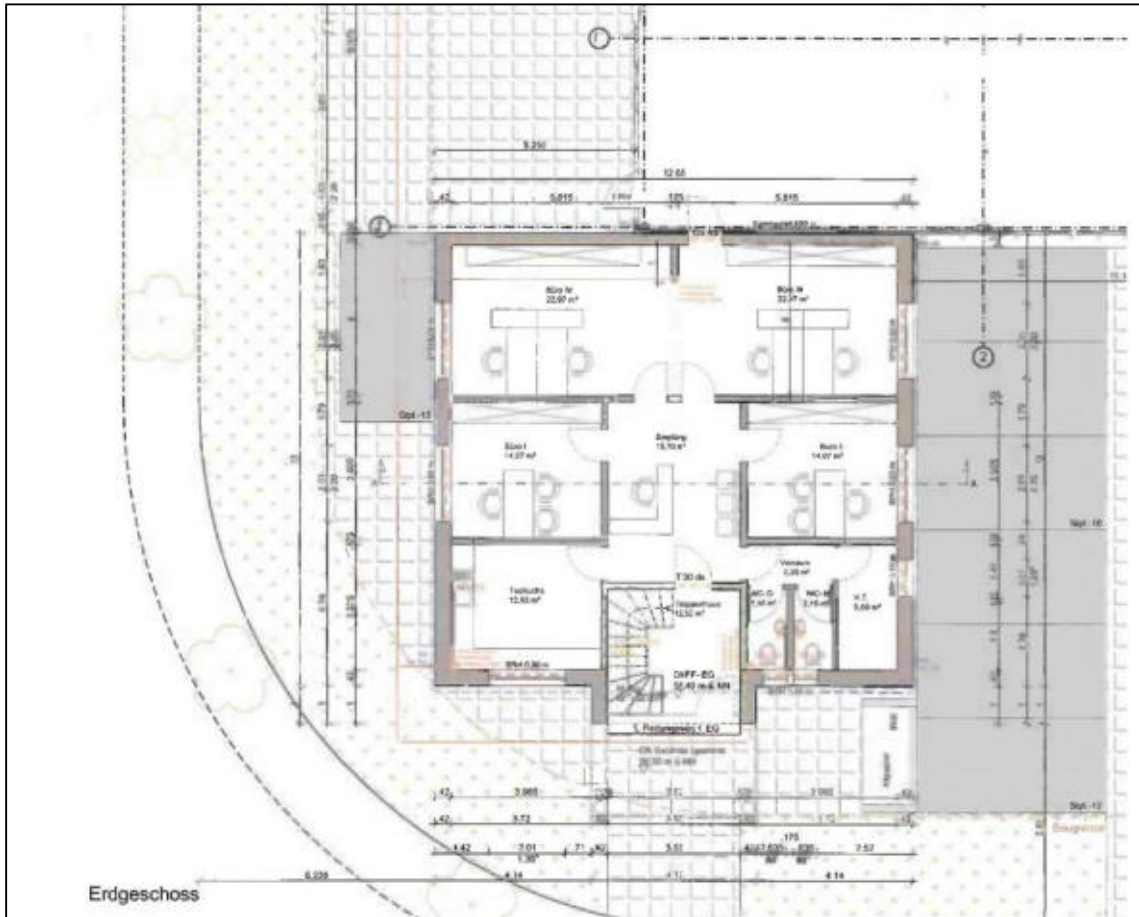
Erdgeschoss-Grundriss vom Verwaltungsgebäude
